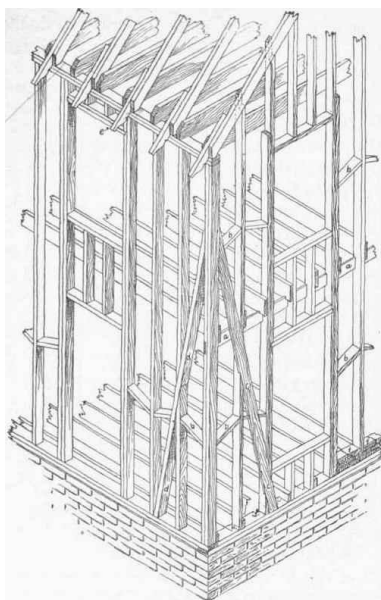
Estrutura em “Balloon Frame” [20]
